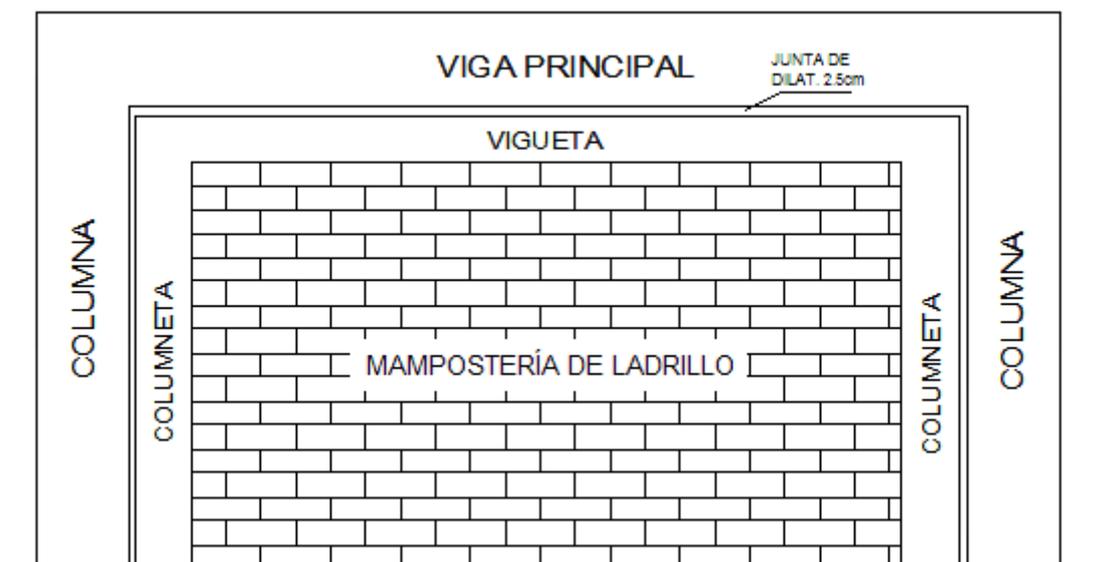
Detalle de tabiquerías en pórticos llenos
